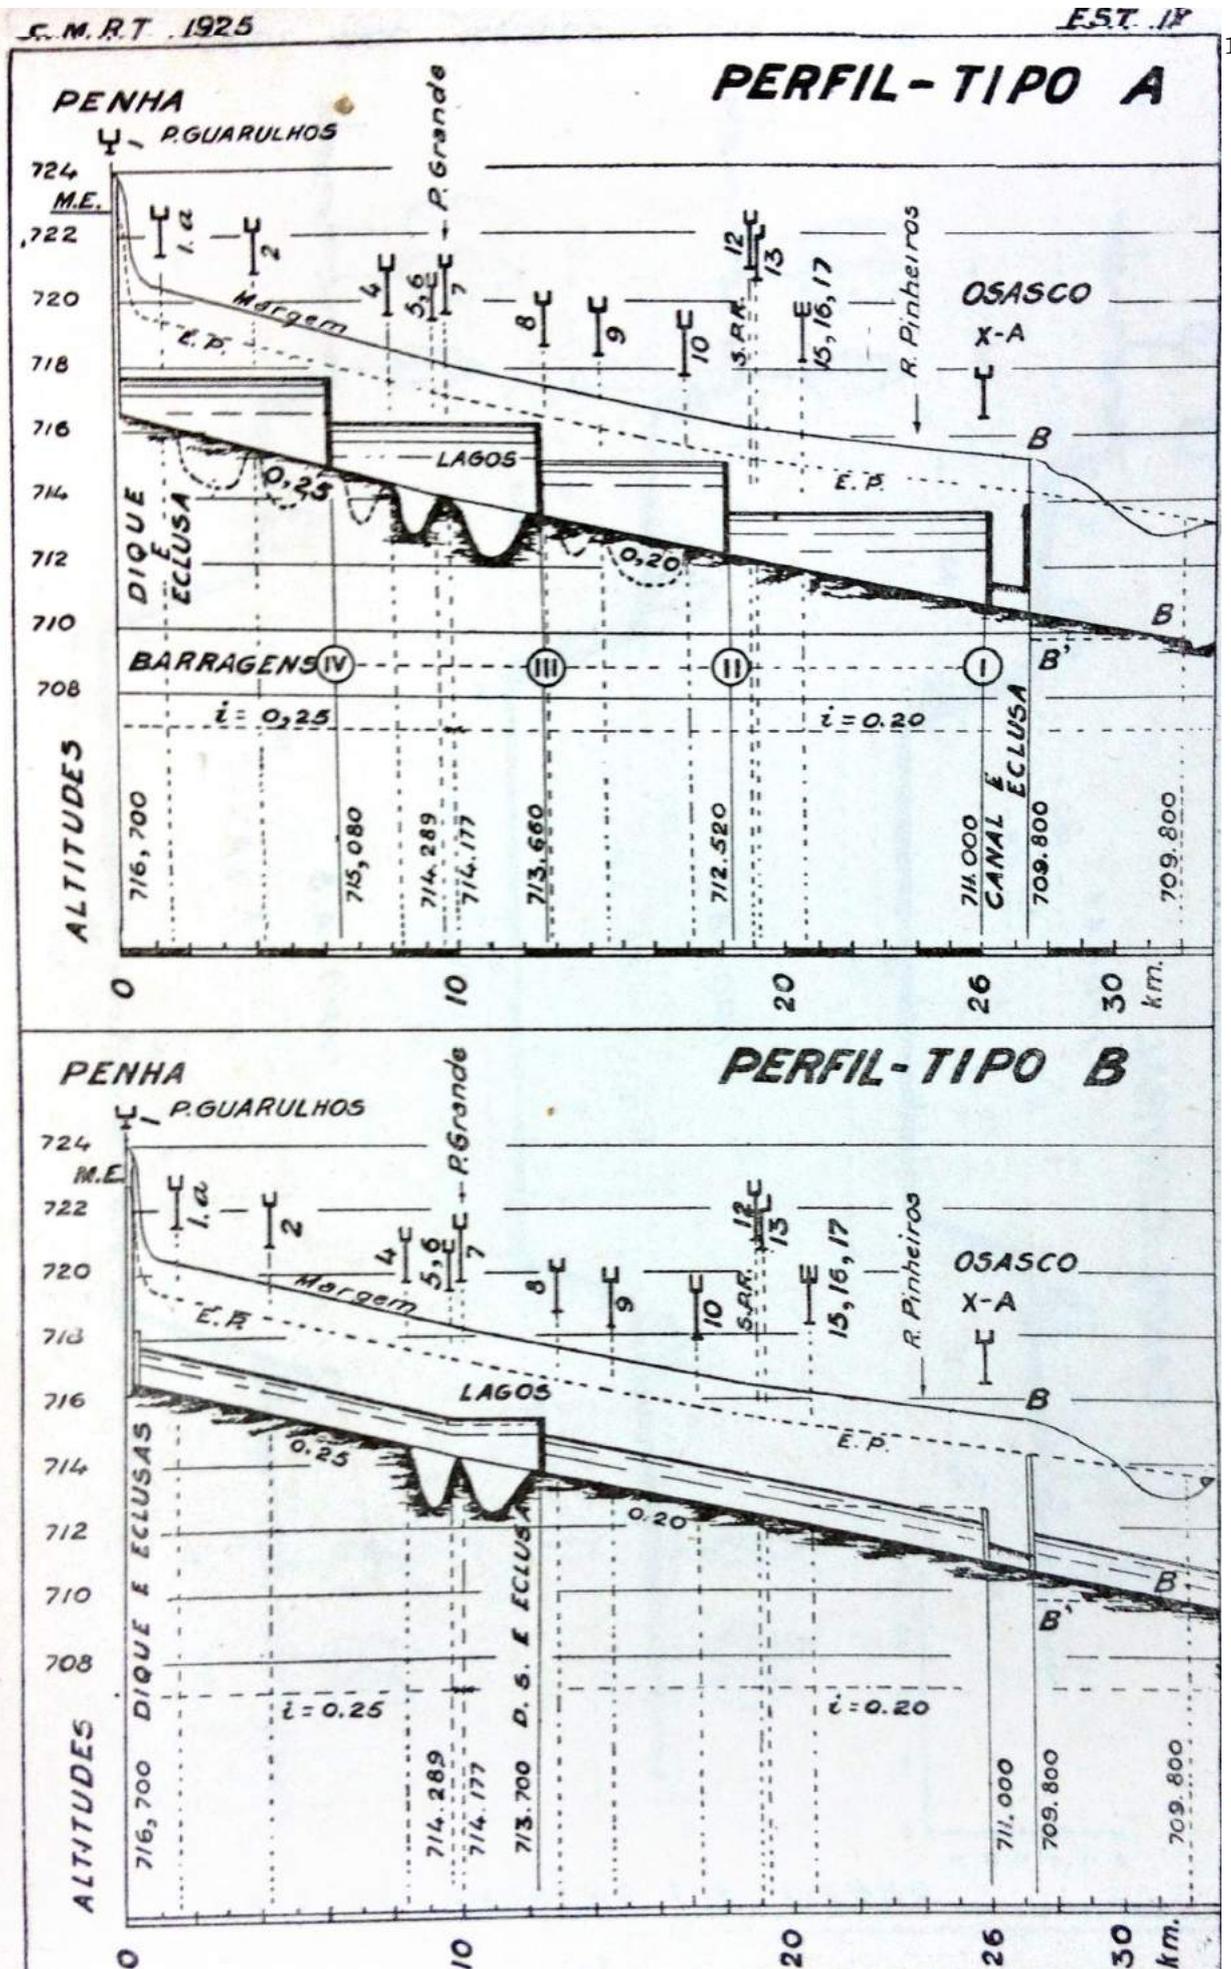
perfis longitudinais do canal retificado Tipo A e B, CMRT I
